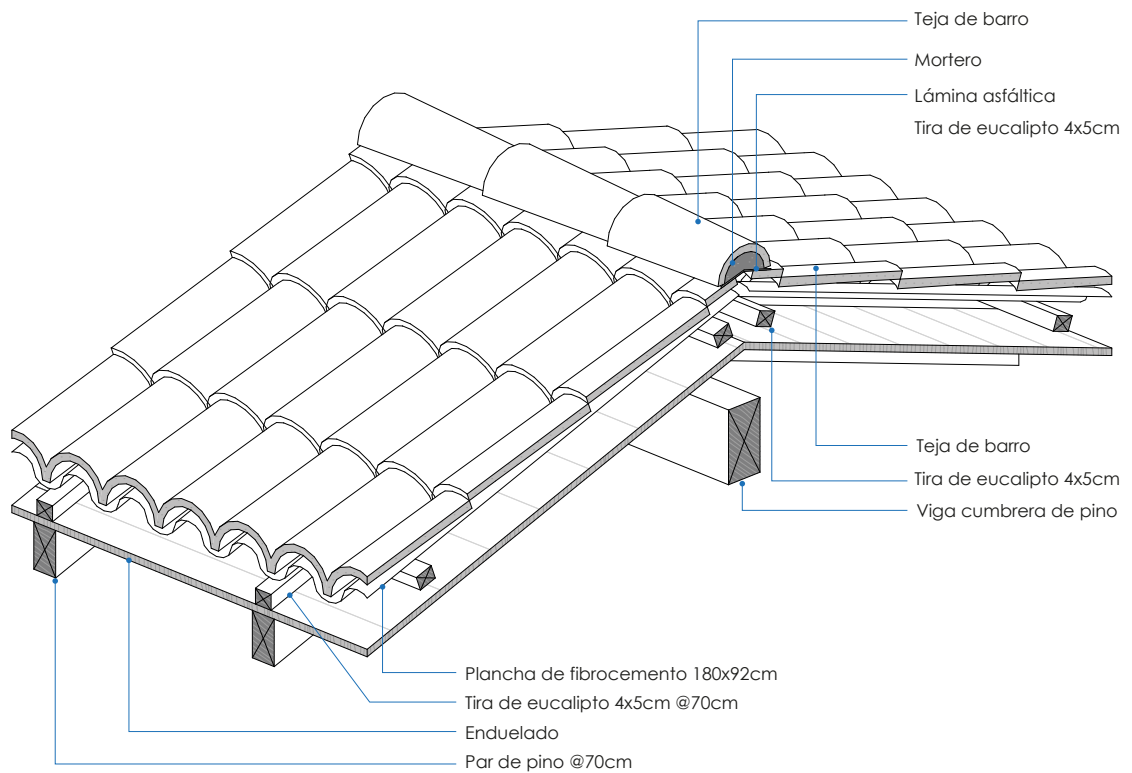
Detalle constructivo: Cubierta a dos aguas
